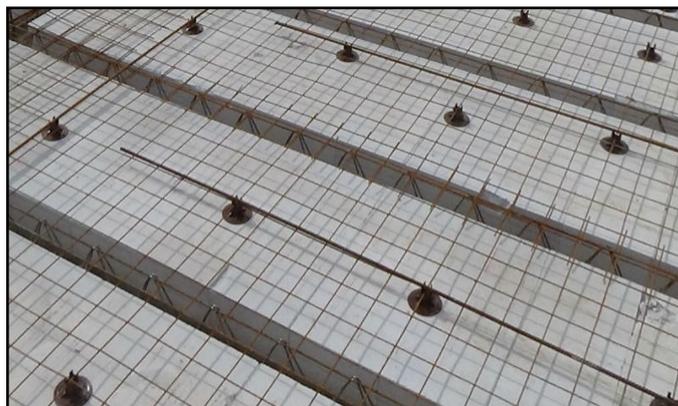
Маяки из арматуры в составе несъемной опалубки перекрытия МАРКО
